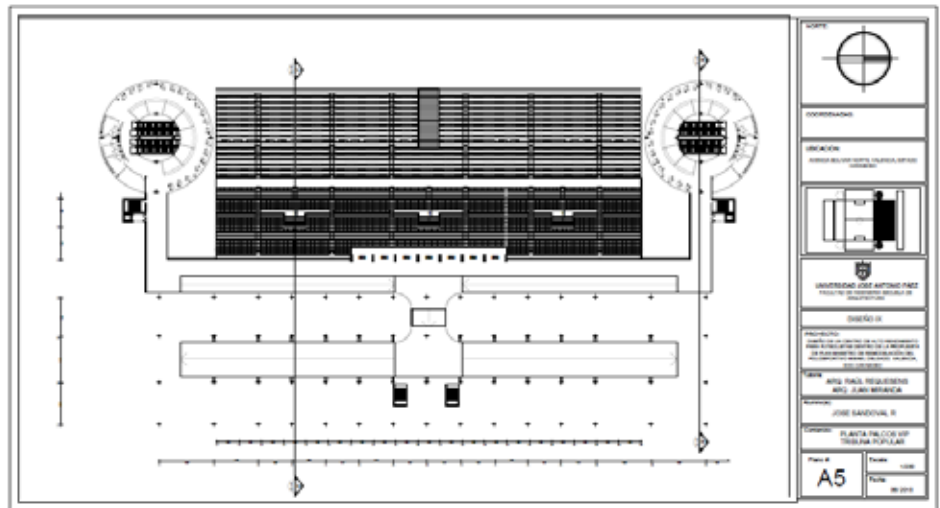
Planta baja Centro de alto rendimiento nivel + 14.50 m. (2018)
